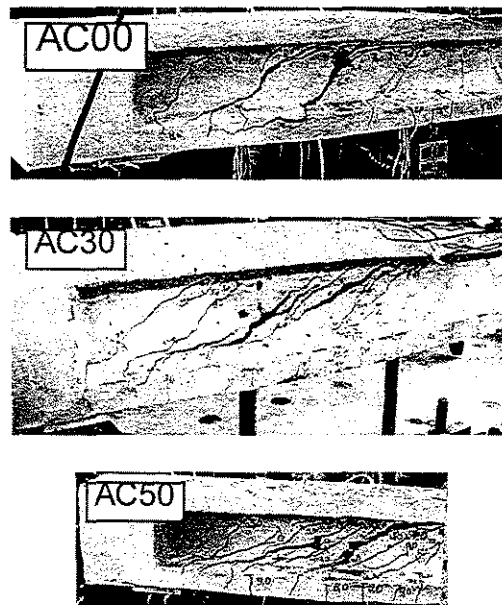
Fissuras horizontais em direção ao apoio das vigas AC
